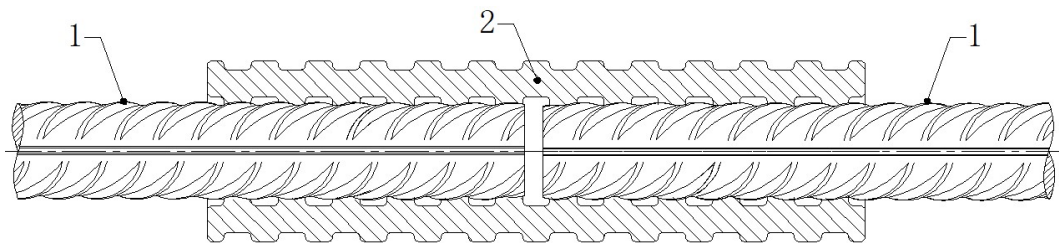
带肋钢筋套筒挤压-直螺纹复合接头示意图3
